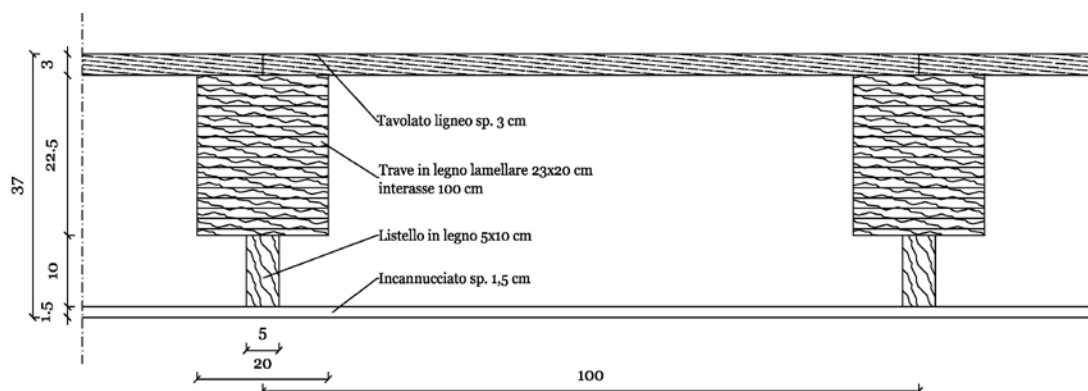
Schema solaio stanza 02.1 – Progetto ing. Jurina
